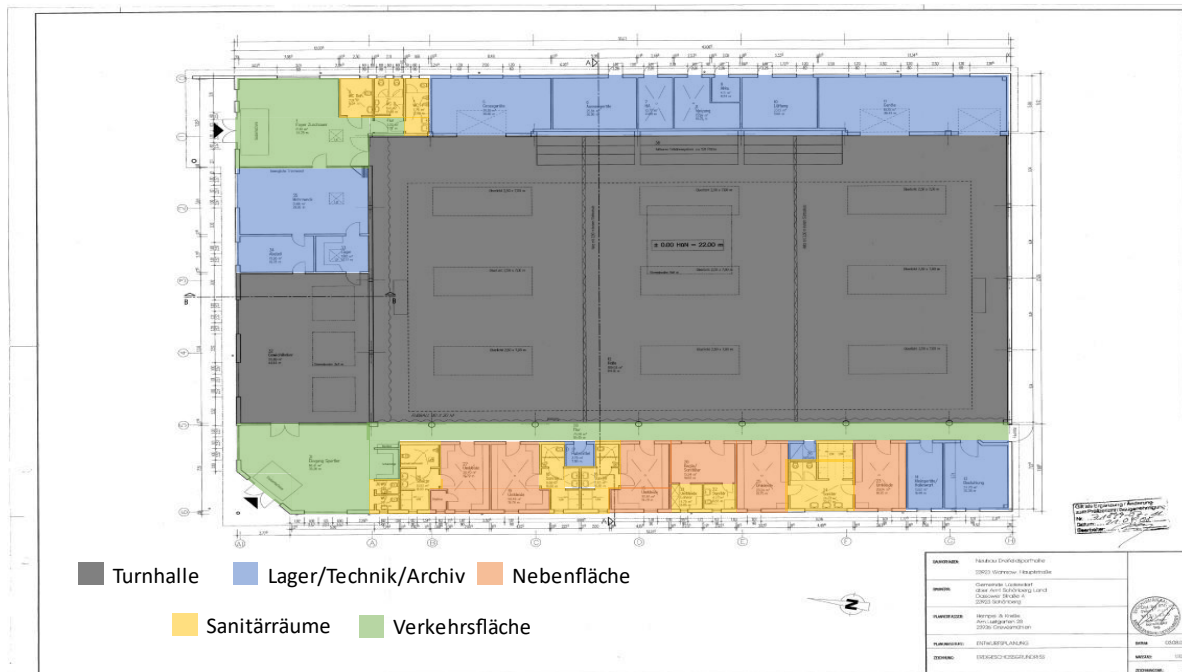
Zonierter Grundriss des untersuchten Gebäudes
